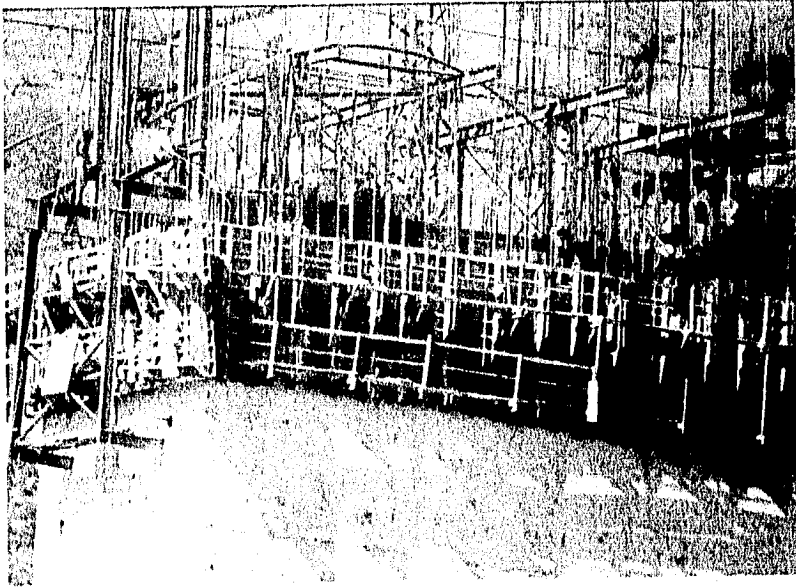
Detalle de la utilización de la cimbra deslizante, en el proceso constructivo del cuerpo de Pila No. 2.
